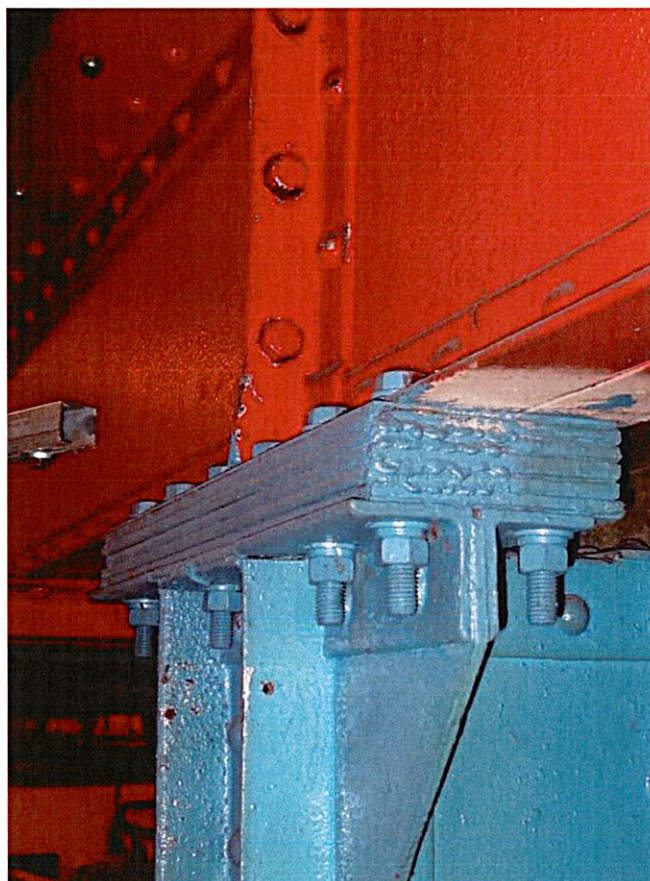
Détail de calage existant des poutres de roulement sur poteaux
